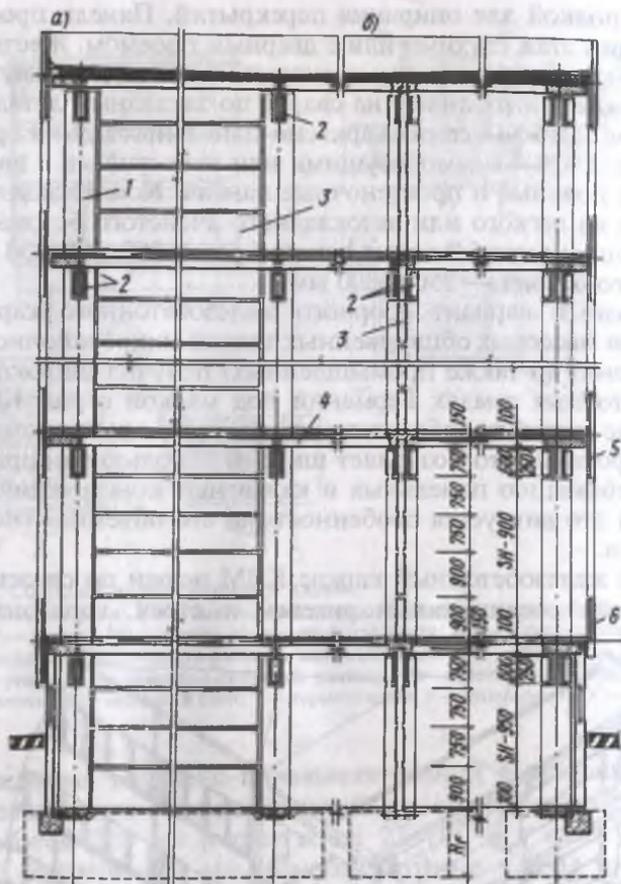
Схема поперечного разреза здания с каркасом КВМ при продольном расположении ригелей:
